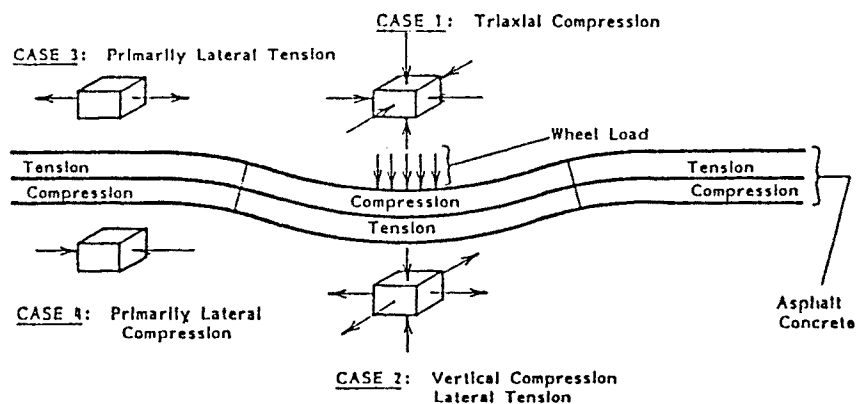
Estado de tensiones en un pavimento bajo una carga simple.
